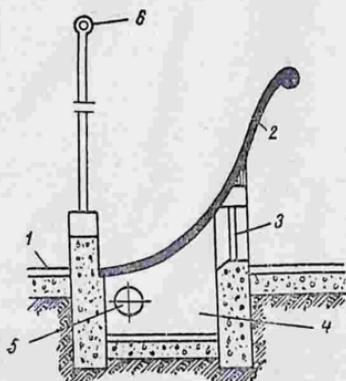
Схема устройства кормушки коровника на ВСХВ для 200 коров:
